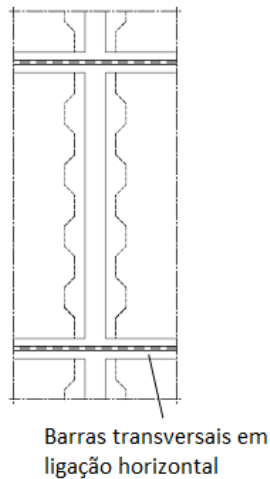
Ligação parede – parede. Adaptado: Fib (2014).
